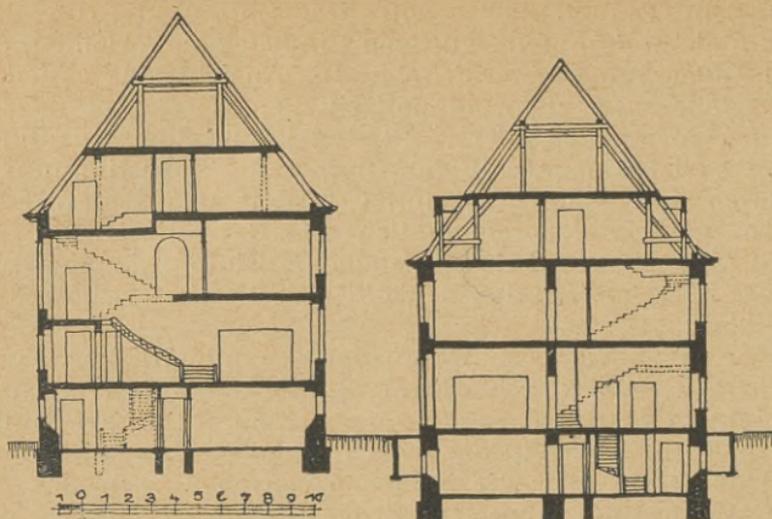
Haus mit bewohnbarem Kellergeschoß
